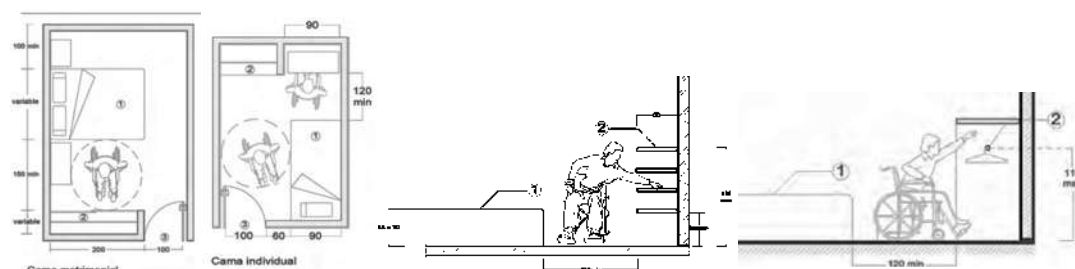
(1) Cama. (2) Áreas de guardado. (3) Ancho puerta.
